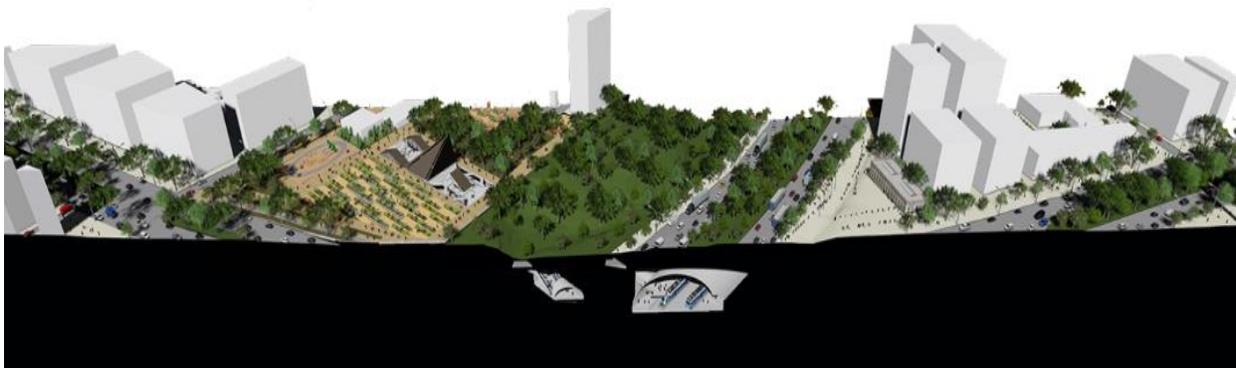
Sección longitudinal del Plan Parcial Tenerife
